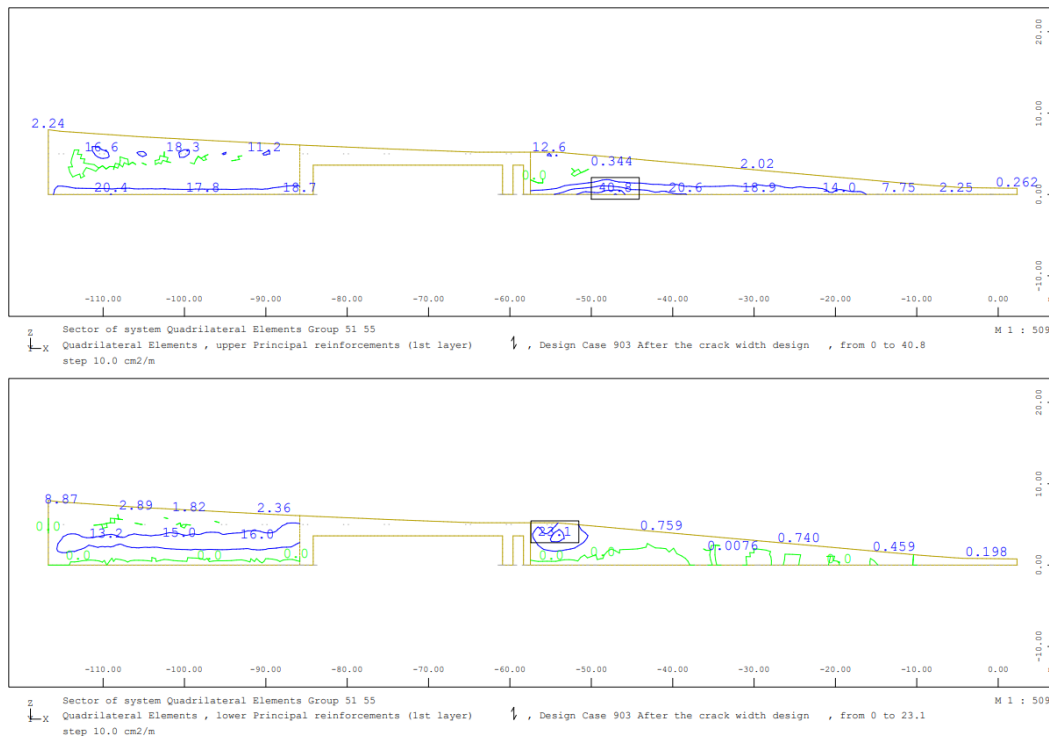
Armadura vertical na face exterior (sup.) e interior (inf.) – fachada Sul da Estação - ELS
